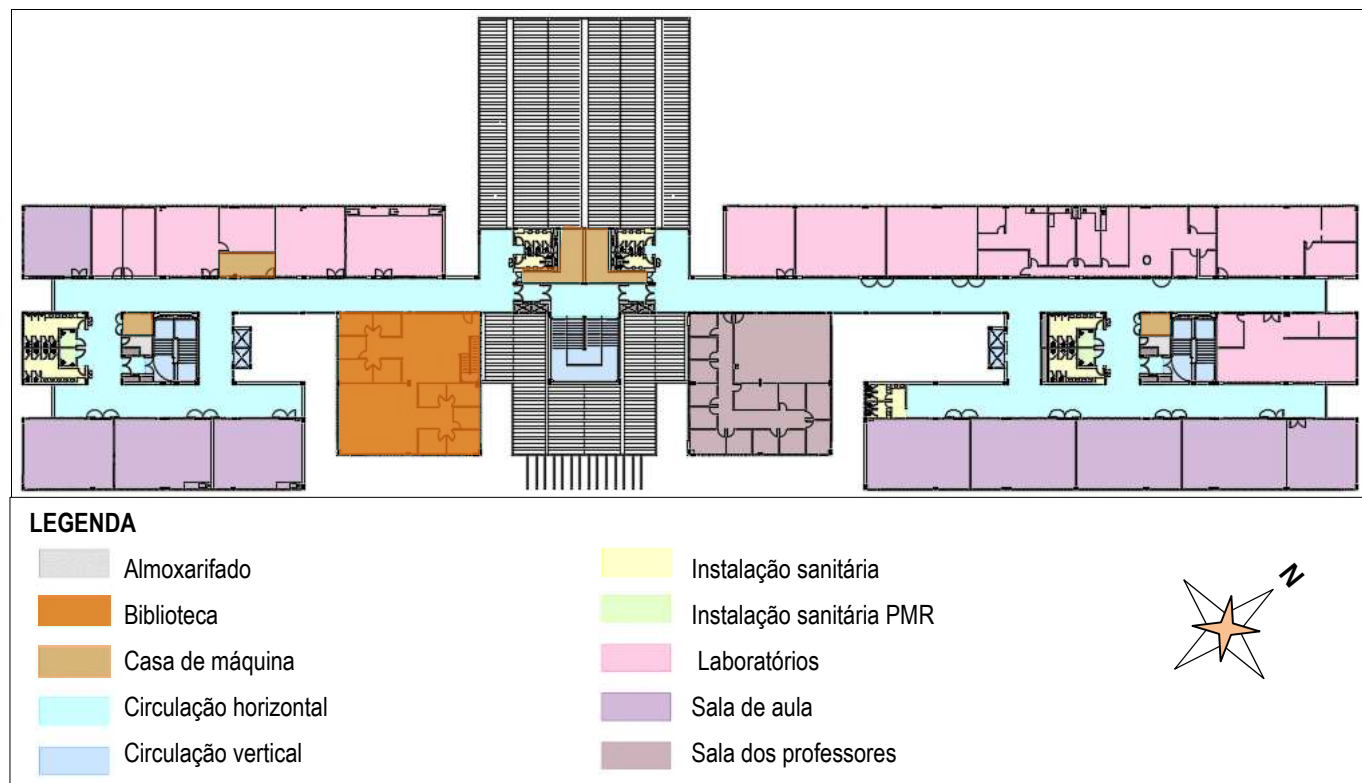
Planta setORIZADA do segundo pavimento do bloco 04.
